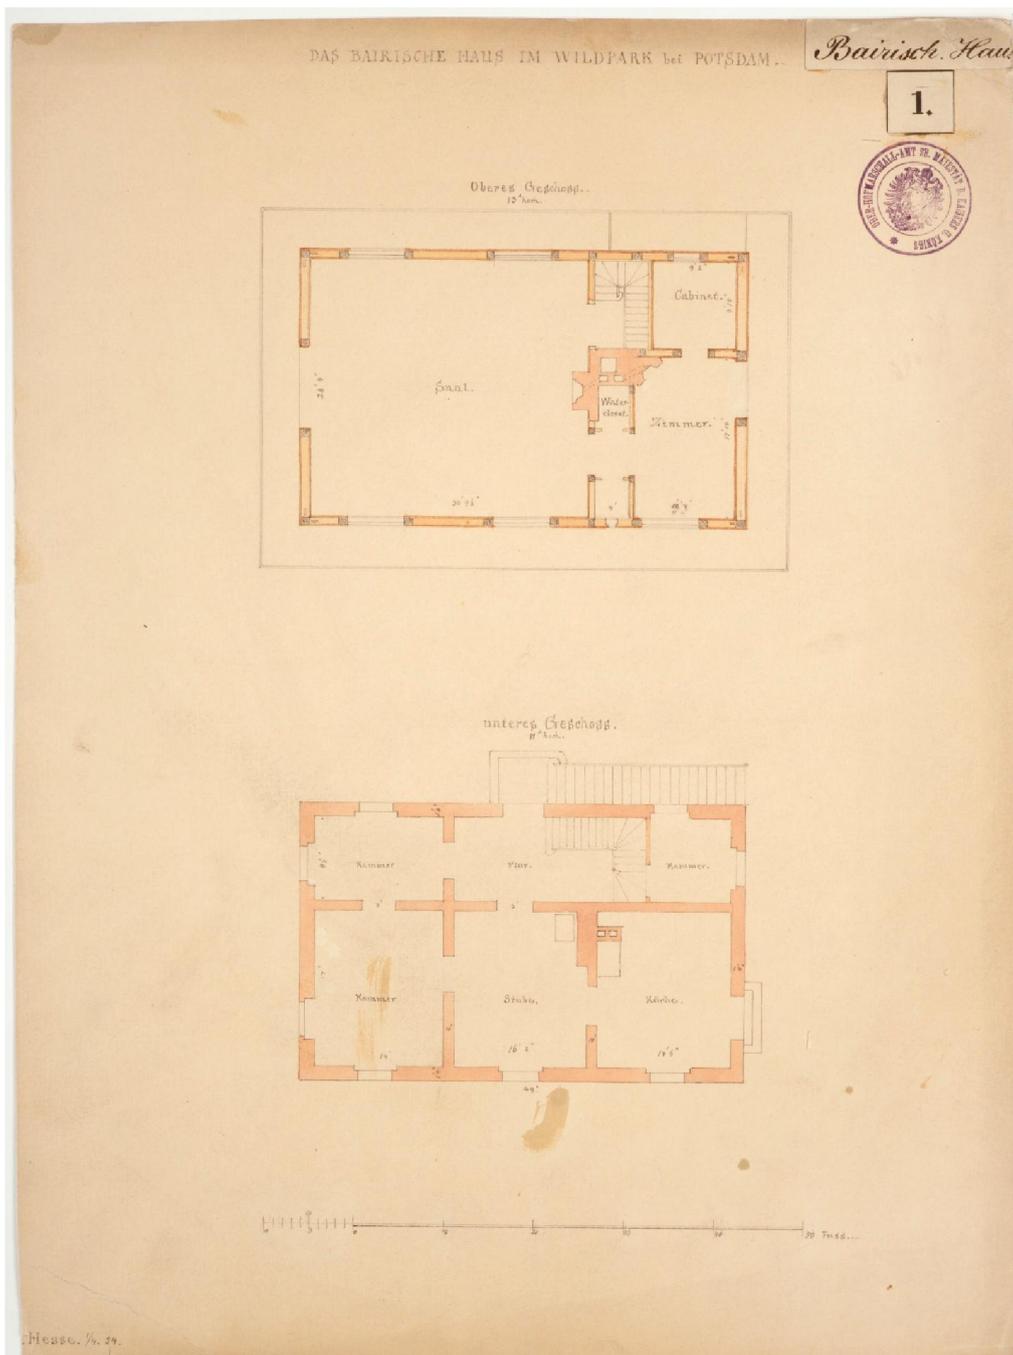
Foto Duras; Februar 2016; Ablichtung, Hesse, Ludwig Ferdinand: Potsdam, Wildpark, Bayrisches Haus, Grundriss, 1854
